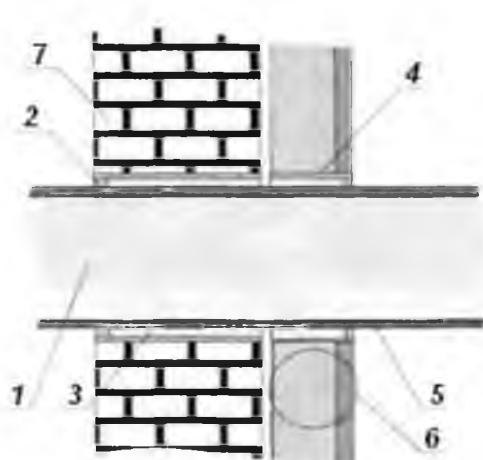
Ділянки з жорсткими повітропроводами: 1 – вентиляційний канал; 2 – віброакустичний силіконовий герметик; 3 – негорюча пружна прокладка; 4 – гільза; 5 – віброізоляючий матеріал; 6 – звукоізоляційне, або звуковбірне облицювання; 7 – стіна або перегородка.
